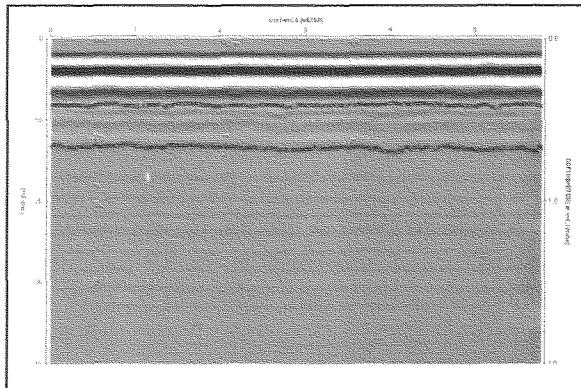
Determinación de capas de pavimento mediante REFLEX-W ®
